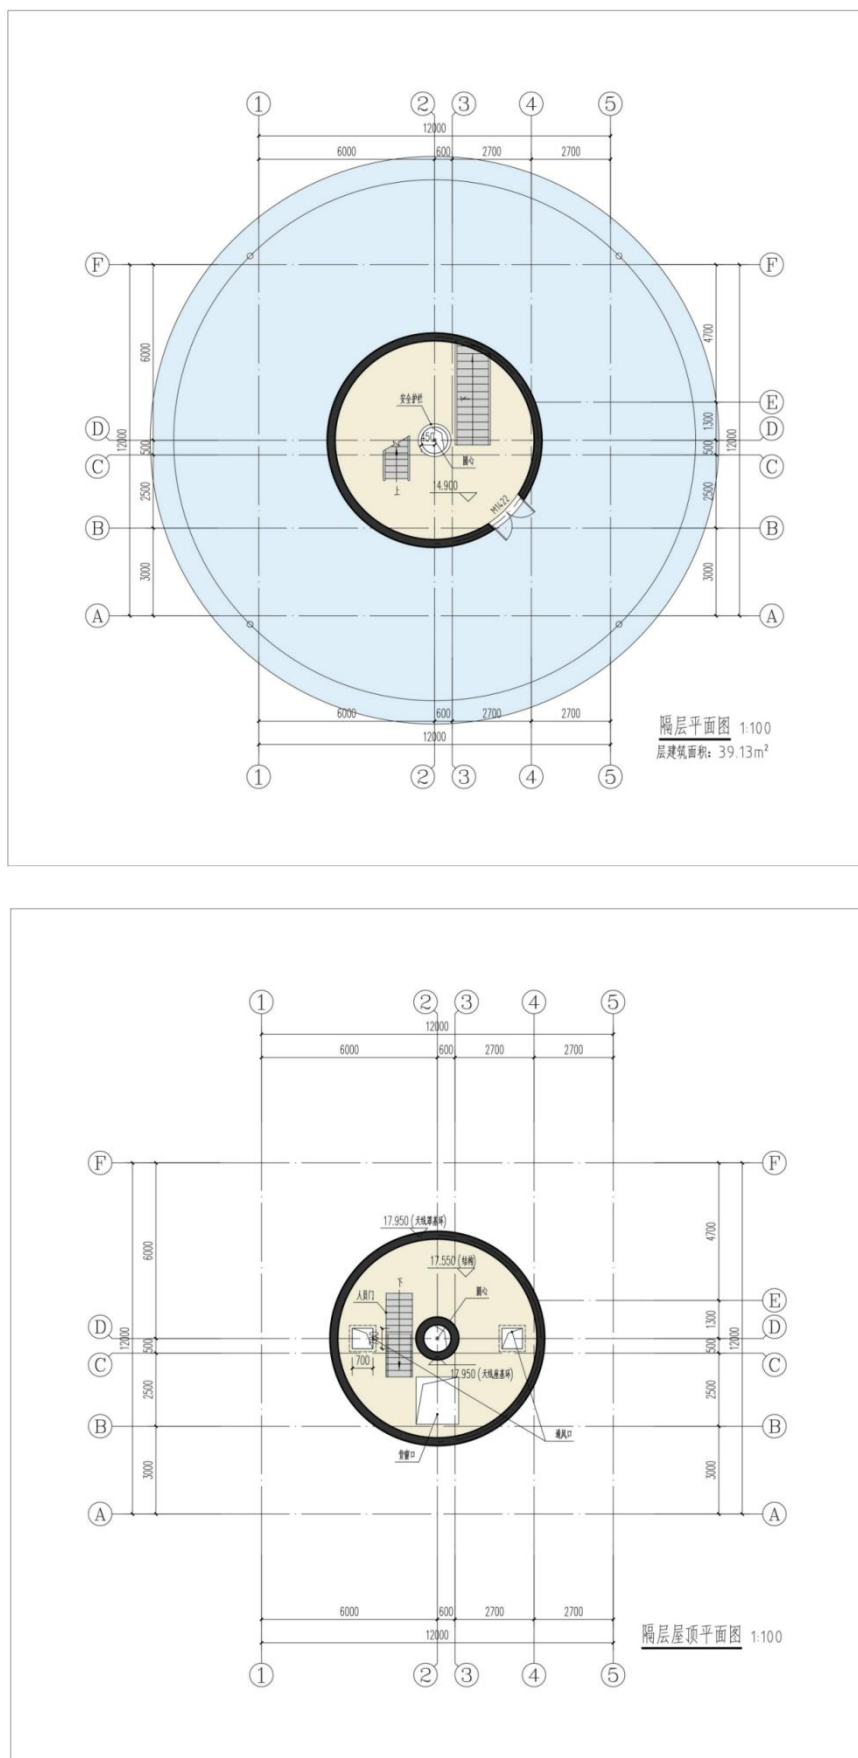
雷达塔楼隔层、隔层屋顶平面布置图
